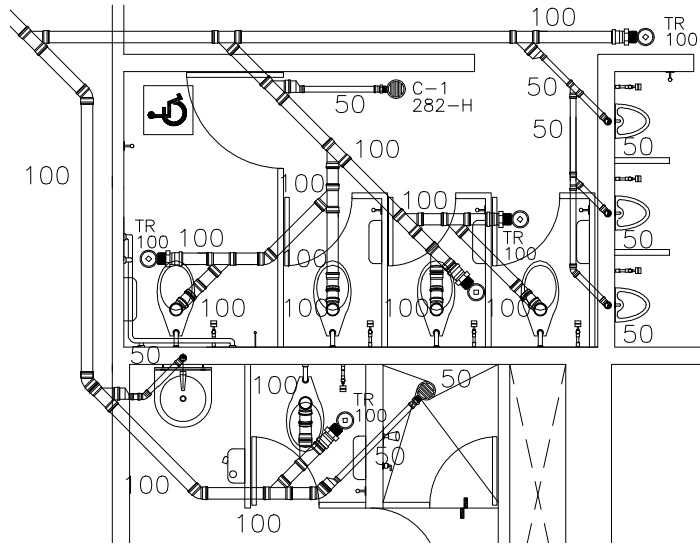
DETALLE INSTALACIÓN SANITARIA
